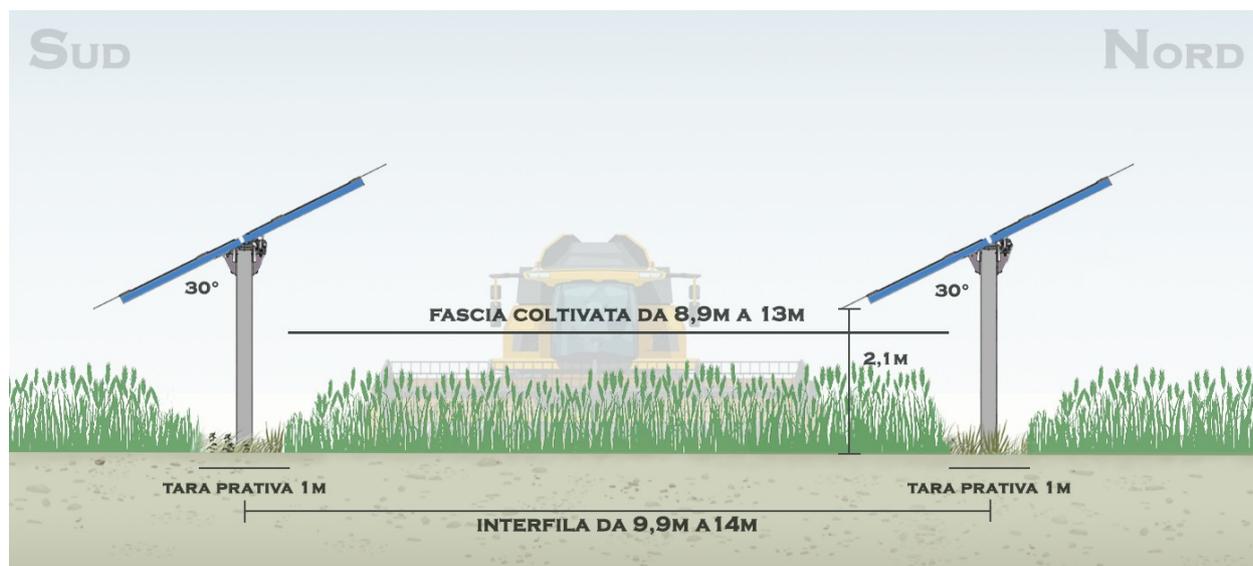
Sezione tipologica di campo con installazione di tipo fisso.
